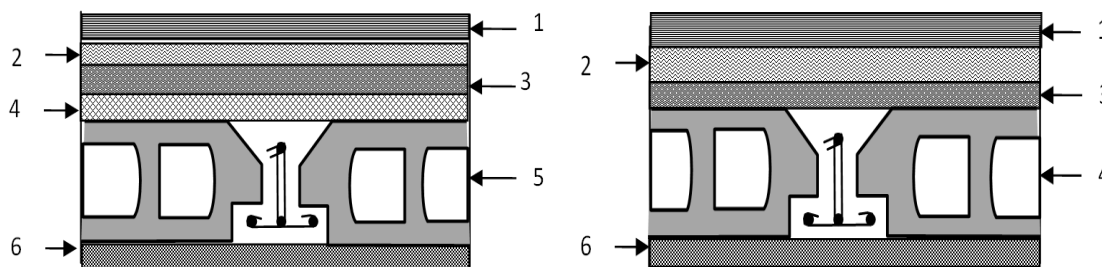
4: Coupe transversale d'un plancher terrasse inaccessible et étage courant
